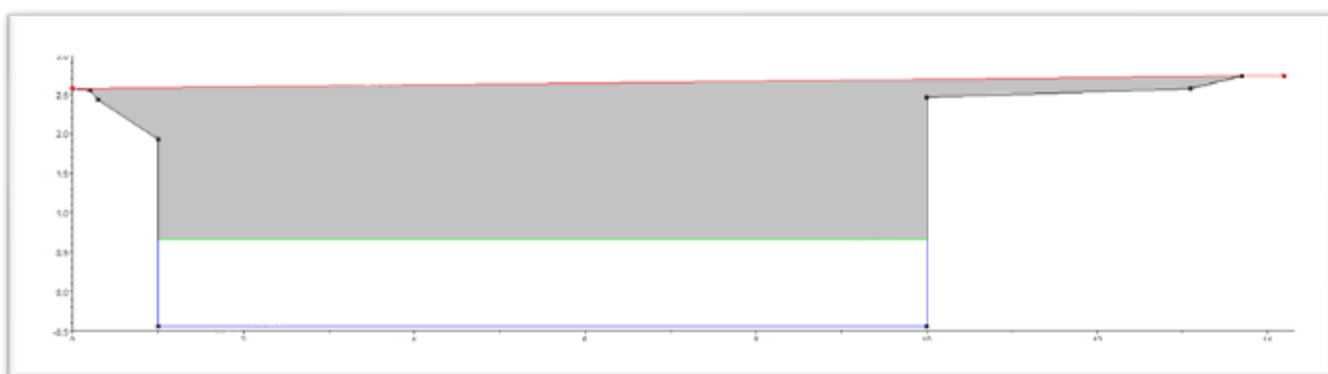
SECTION AMONT DE L'OUVRAGE DE FRANCHISSEMENT DE LA RT
